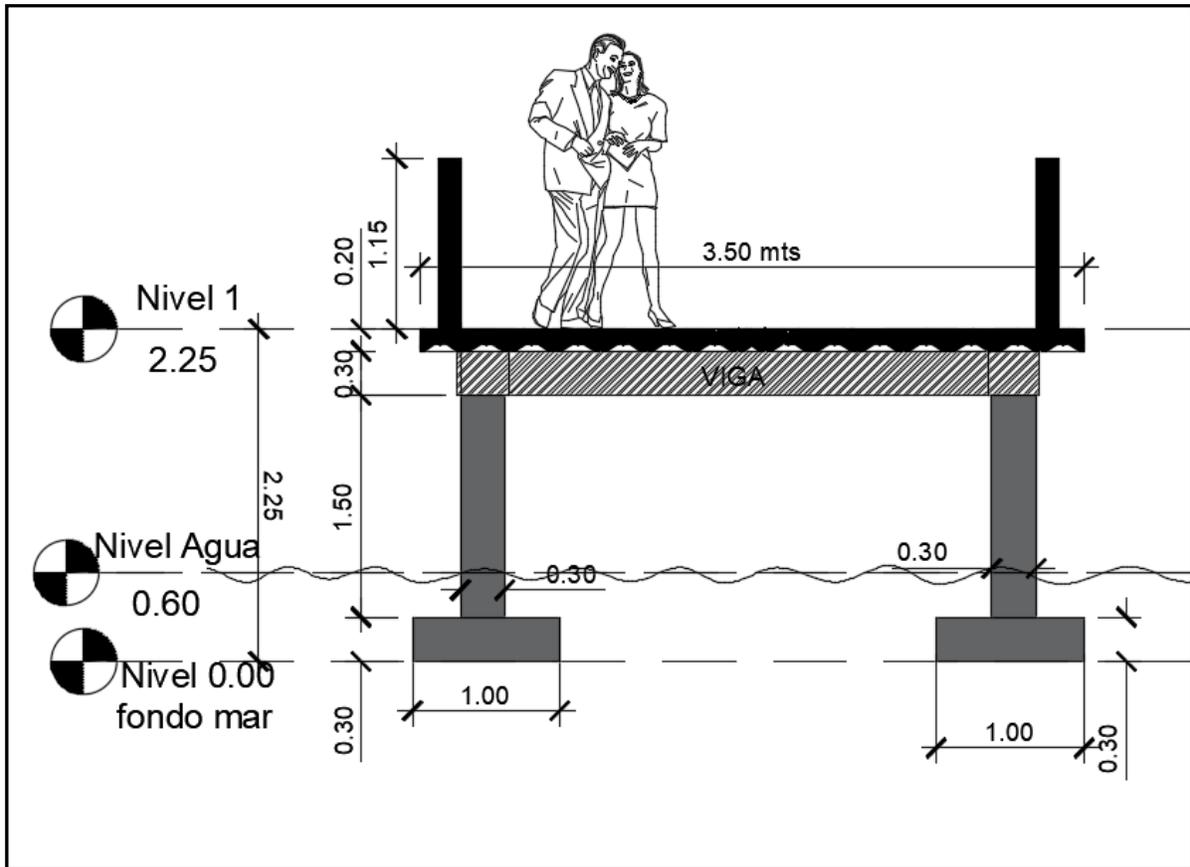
Sección de base-columna-viga-altura-niveles de agua y otros detalles del muelle.
